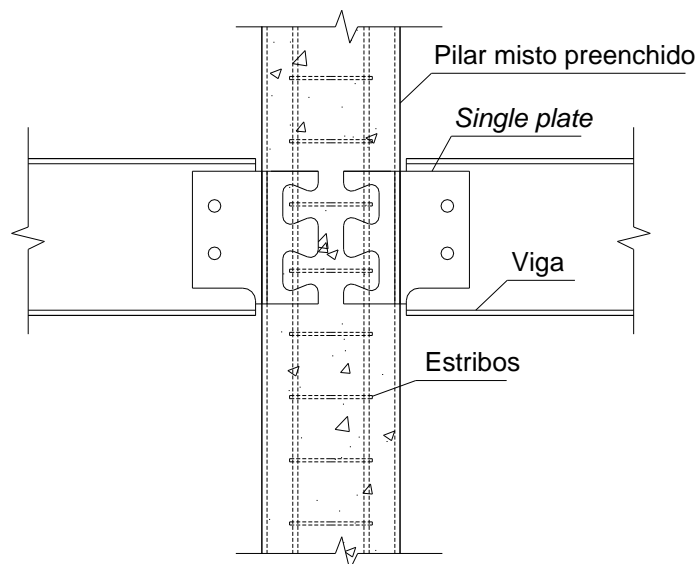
Conector Crestbond com *single plate* (ligação com chapa simples), viga ligada e armaduras do pilar (Caldas *et al.*, 2010).
